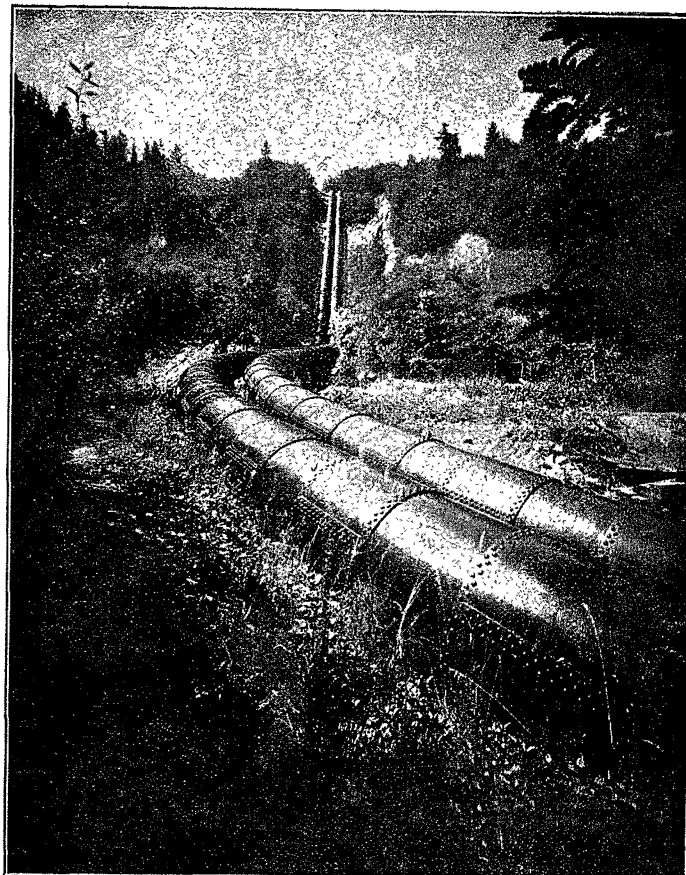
Conduites forcées de l'usine du Fayet sur le Bonnant. Hauteur de chute : 165 mètres. — Puissance installée : 15.000 HP.
